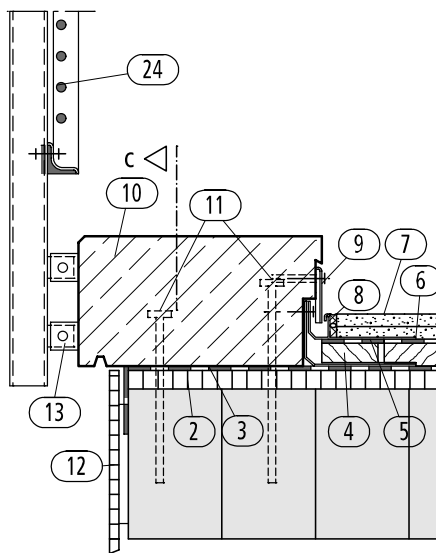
Schrammbord aus Beton, SLW 30-Brücke
